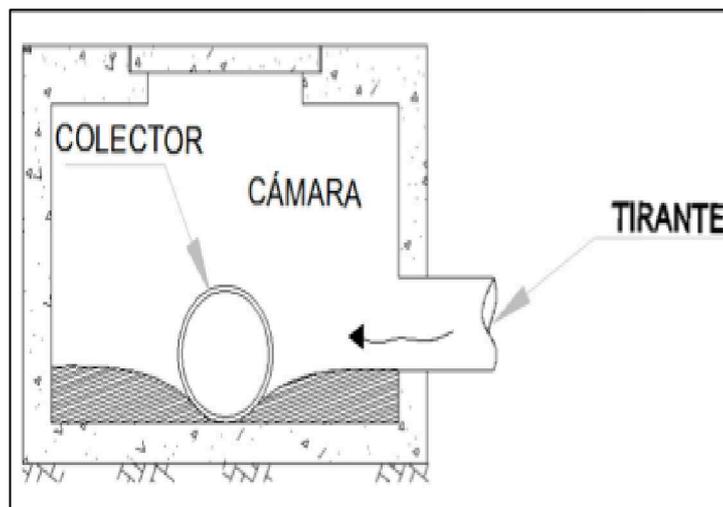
Partes de un sistema de alcantarillado pluvial
